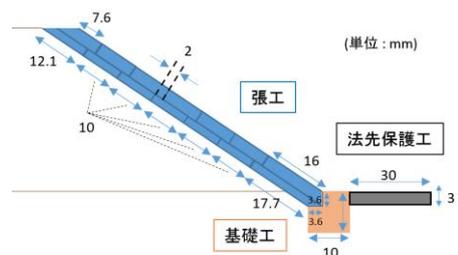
張工, 基礎工, 法先保護工 配置図及び寸法
